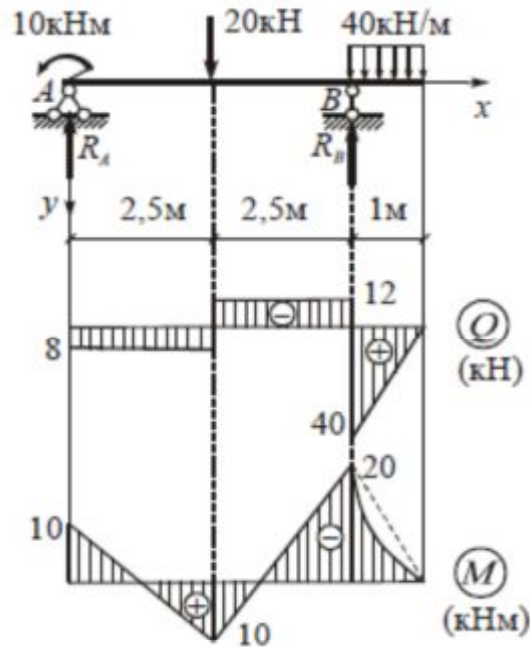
Расчетная схема балки, эпюры внутренних усилий Q , M
